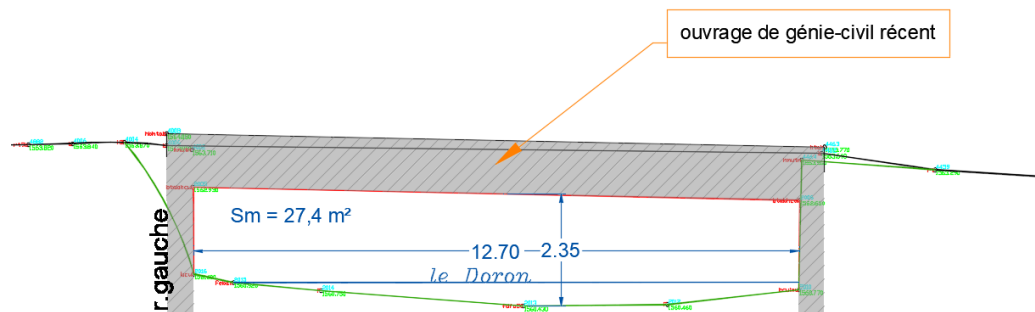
Ouvrage traversant n°2 – profil topographique (face amont)
